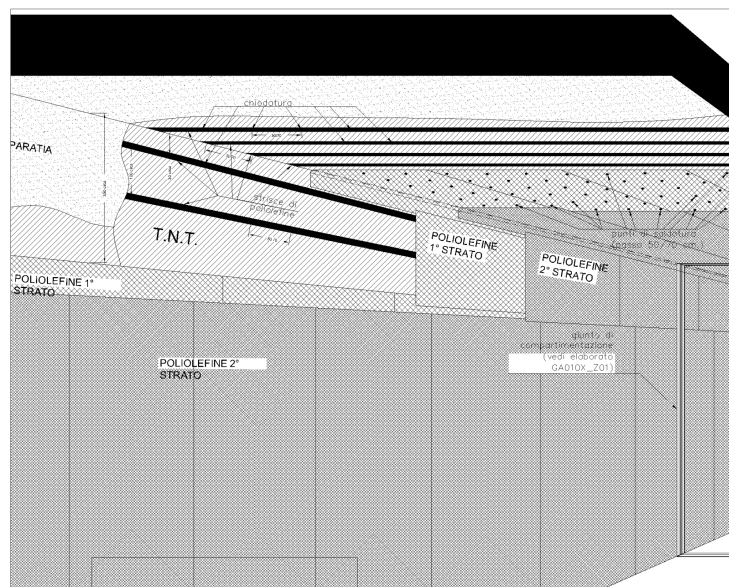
Schema di posa impermeabilizzazione nella zona di sottoattraversamento fiume Dora. Diagram showing the positioning of the waterproofing in the zone of the river Dora underpass. (welding points; pitch 50/70 cm; riveting; bulkhead; strips of polyolefin; polyolefin; polyolefin; 1st layer; 2nd layer; polyolefin; compartmentalisation joints; 1st layer; (see print-out GA10X_201); polyolefin; 2nd layer).
